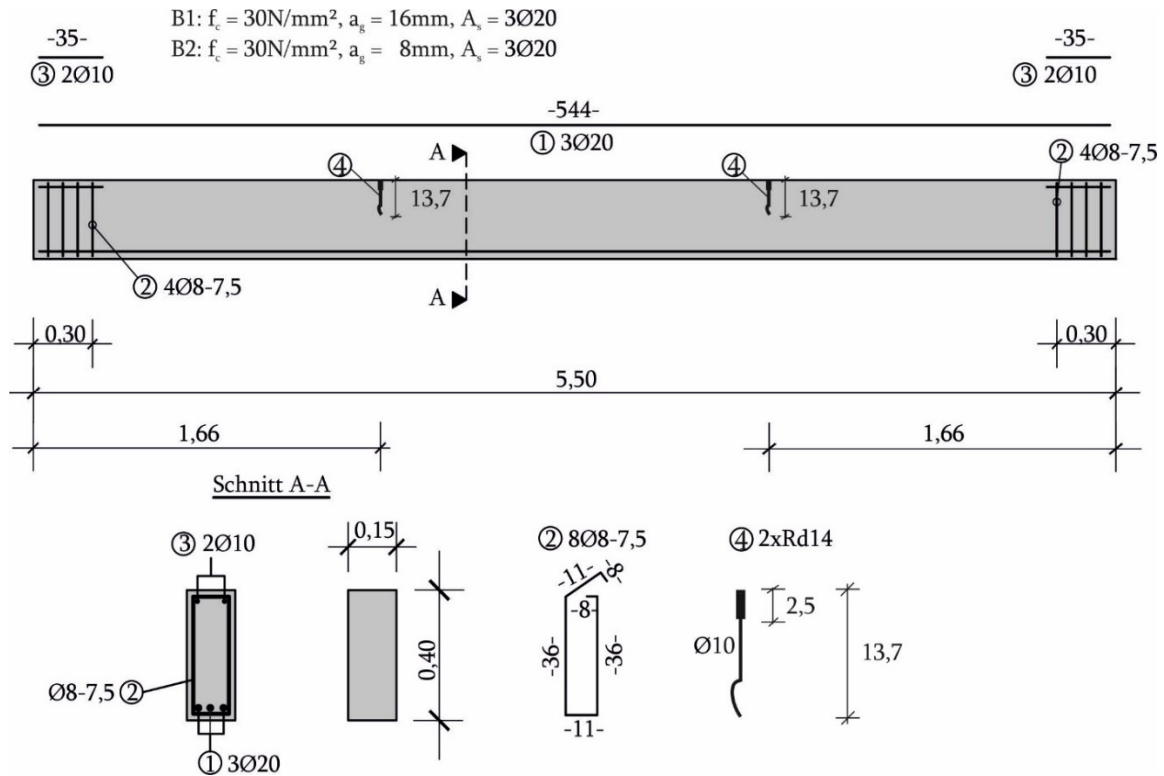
Schal- und Bewehrungsplan der Balken B1 und B2 (Balkentyp I)
